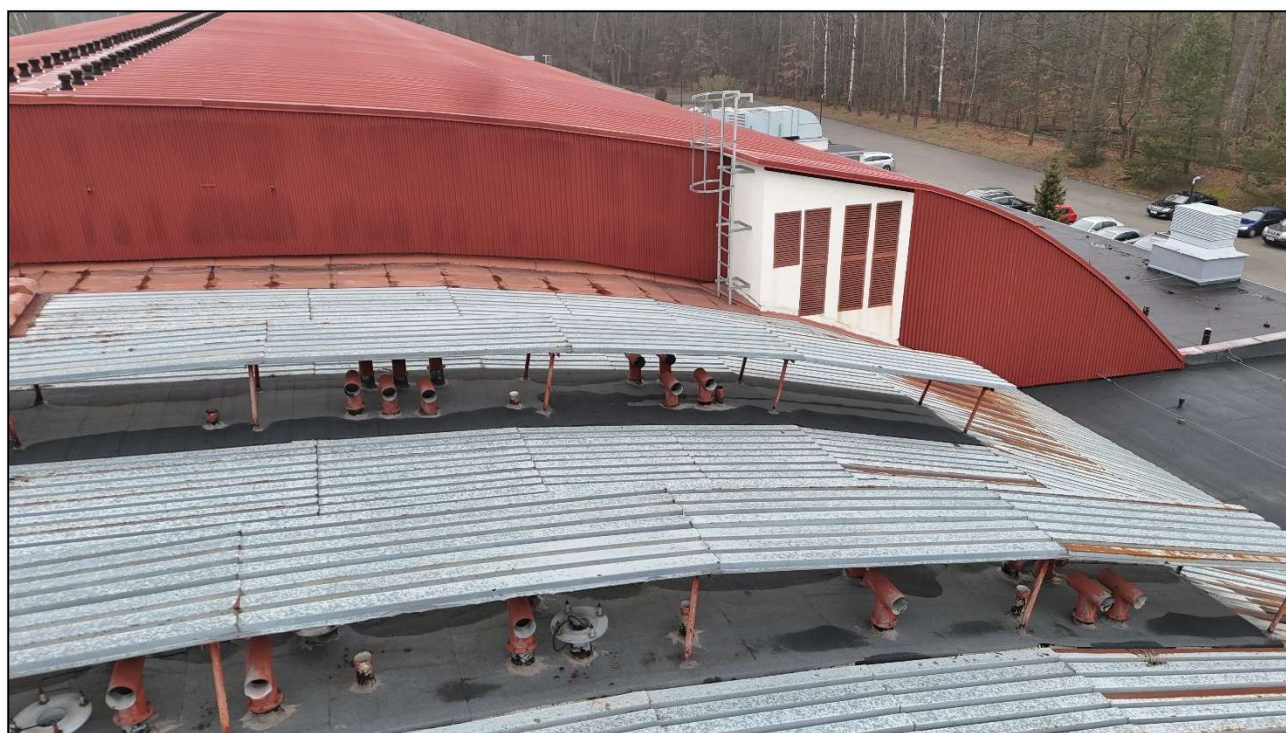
Detal połączenia budynku pływalni z halą sportową – stan techniczny dobry. (fot. Rafał Fit)
